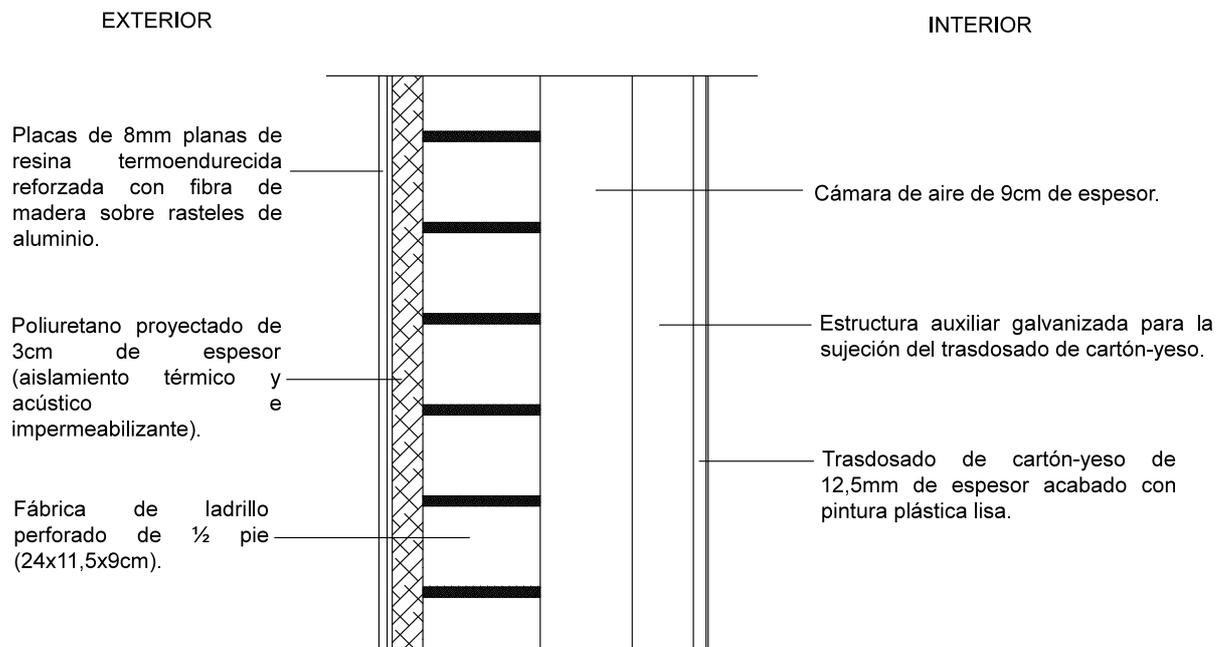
Detalle constructivo cerramiento solución ventilada.
